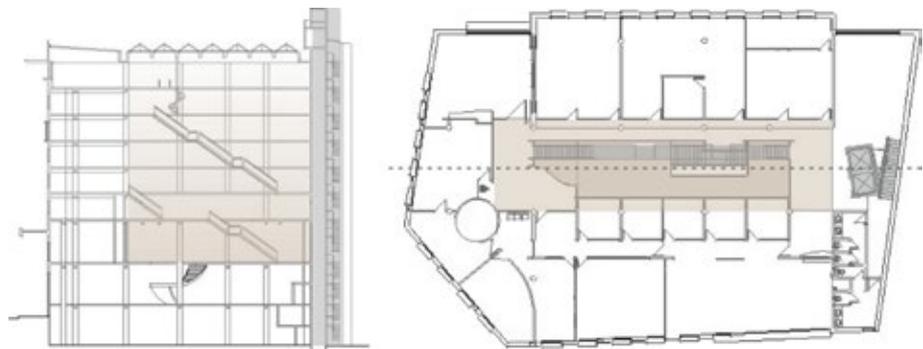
| Corte longitudinal y plantas tipo de la intervención.
